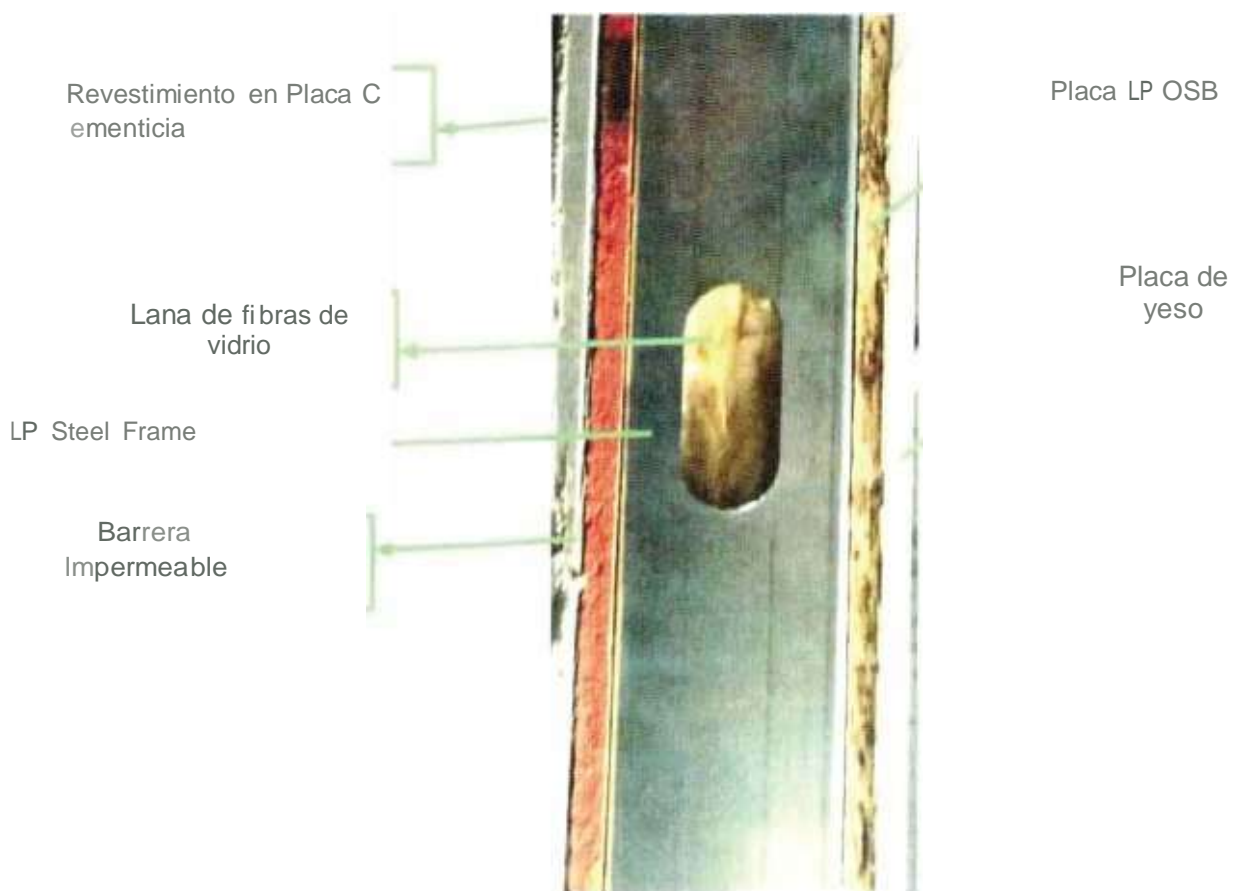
Detalle de las capas del sistema de fachada ensayado.
